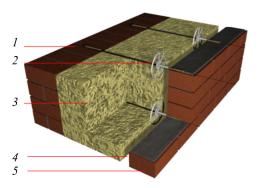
Схема трехслойной стены: 1 – внутренняя часть стены; 2 – гибкая связь; 3 – утеплитель; 4 – воздушный зазор; 5 – облицовочная часть стены
